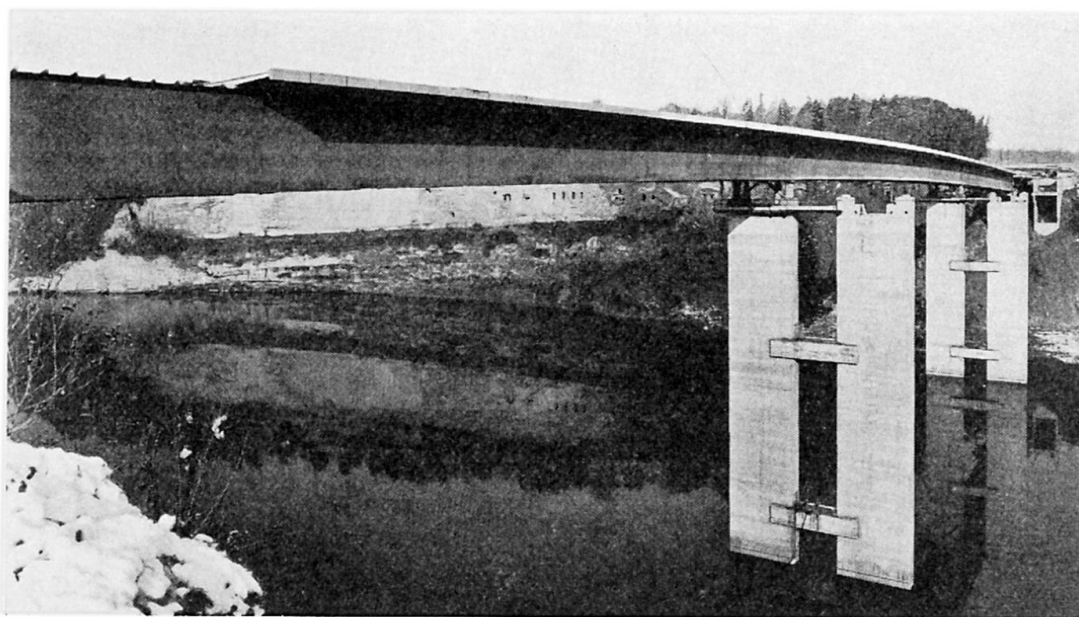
Ensemble du pont sur la Sarine, surélevé de 1,60 m sur piles.
